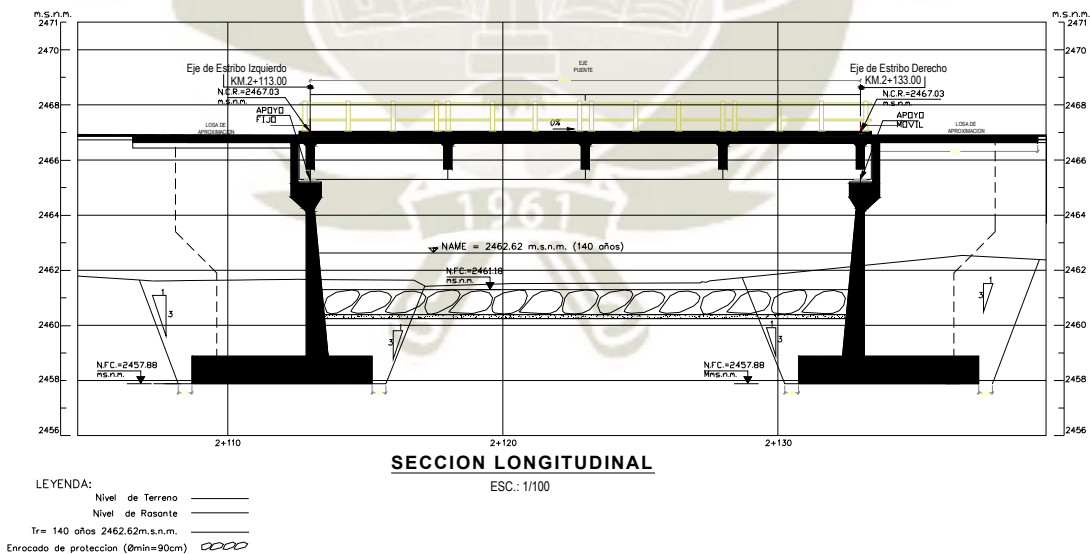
Corte longitudinal puente tipo alcantarilla
